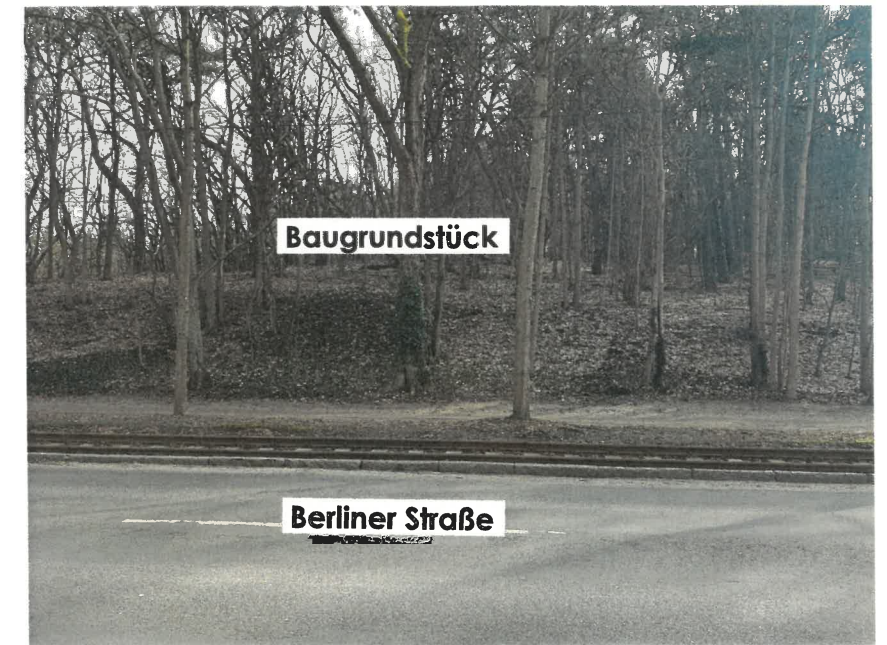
Blick in Richtung Osten von der Berliner Straße auf das Baugrundstück
